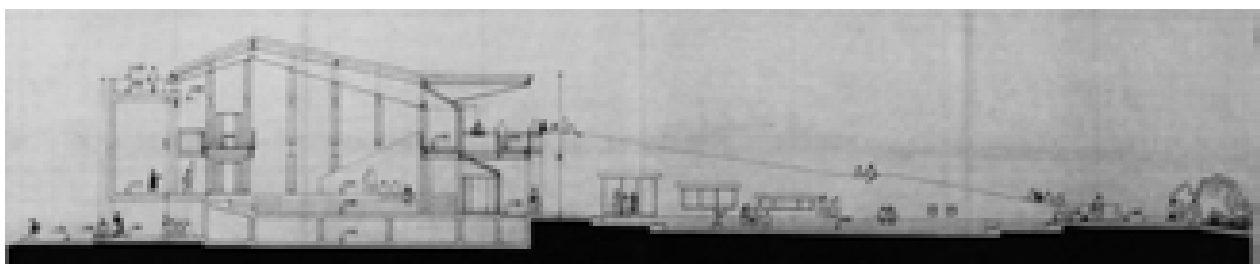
Sezione CC, stato attuale –09/12/1997 (AABS-1996.509)
